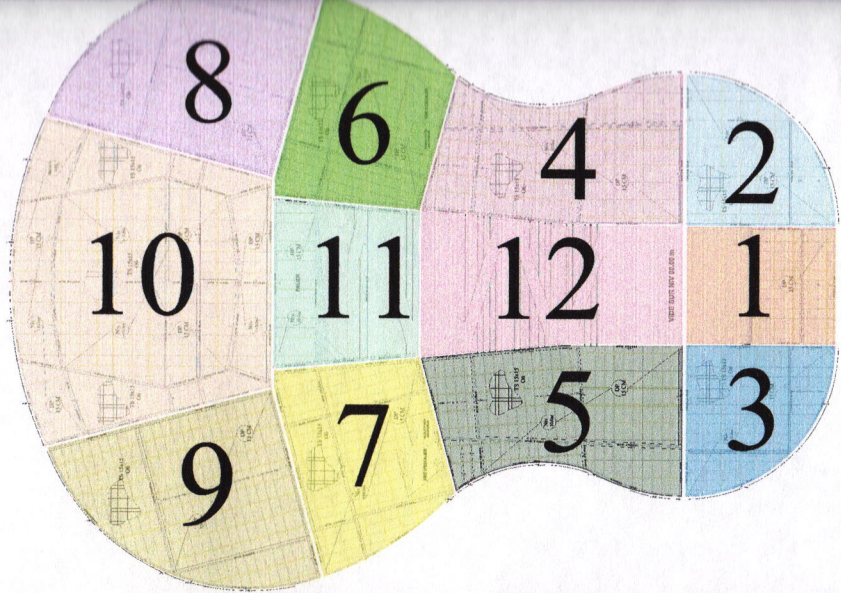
PLAN DE COFFRAGE DE CENTRE CULTUREL
